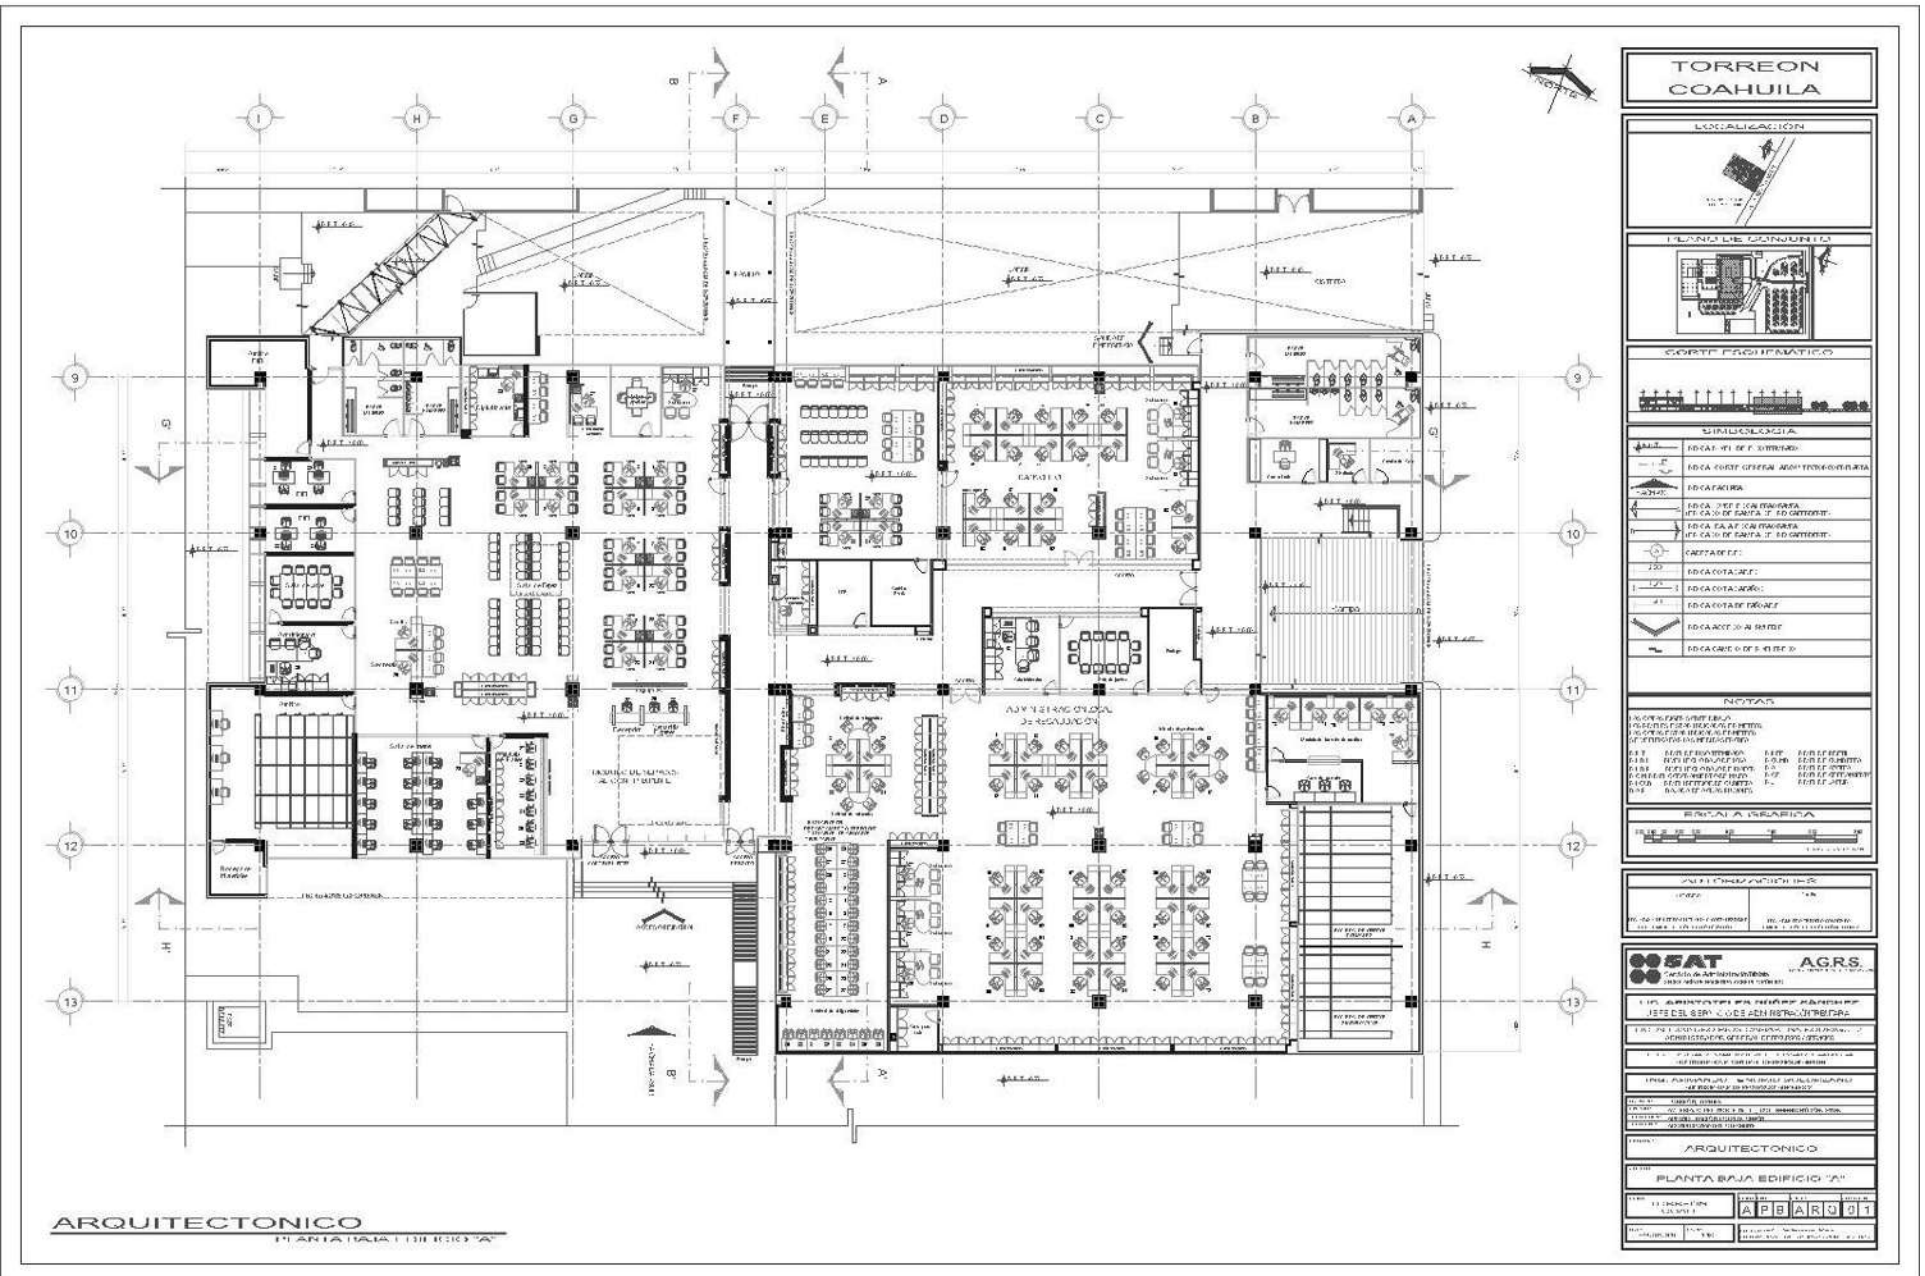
A-PB-ARQ-01 Planta baja edificio A
